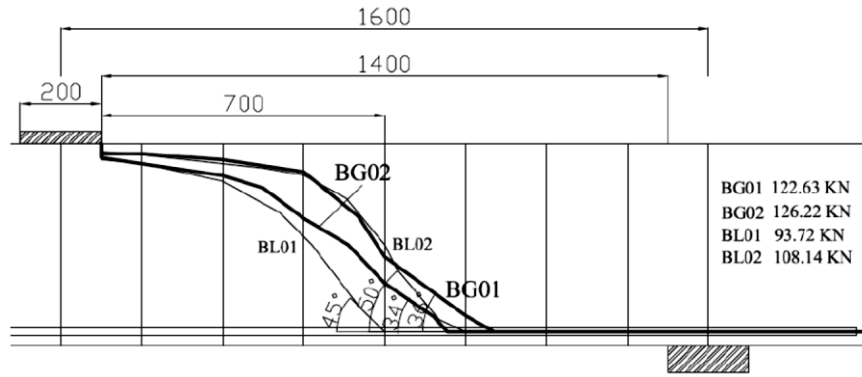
Mapa de fissuração das vigas ensaiadas (SAGASETA, 2008)
